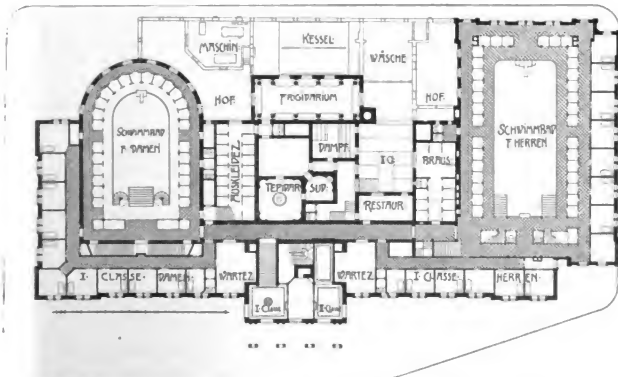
Grundriss der Badeanstalt am Bahnhofplatz. G. Runge. 1875.
